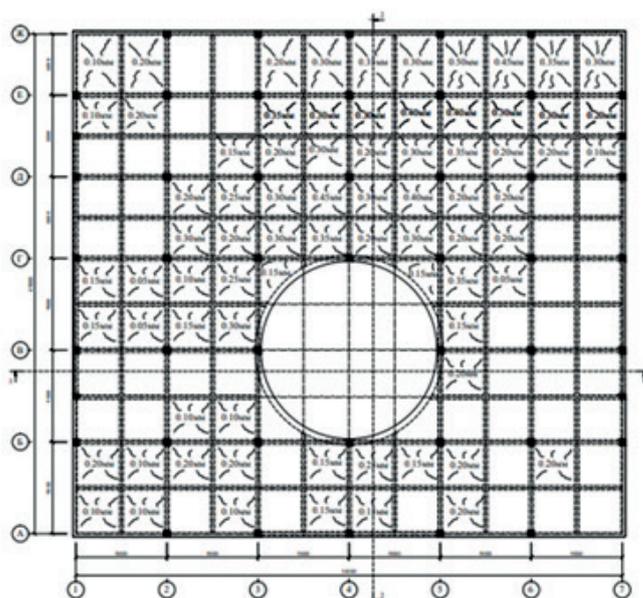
Схема расположения трещин в плите перекрытия верхнего яруса
